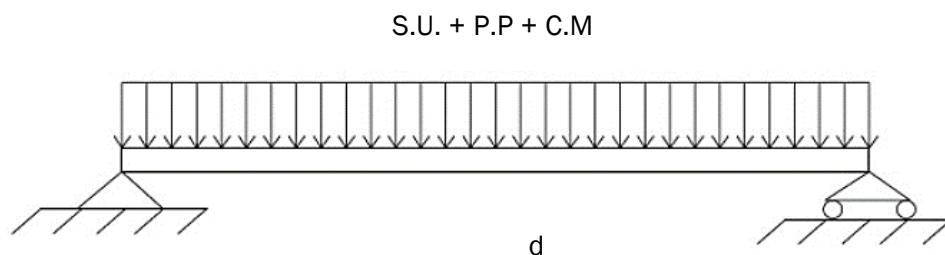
Estado de cargas de la viga 1. Fuentes: Elaboración propia.
